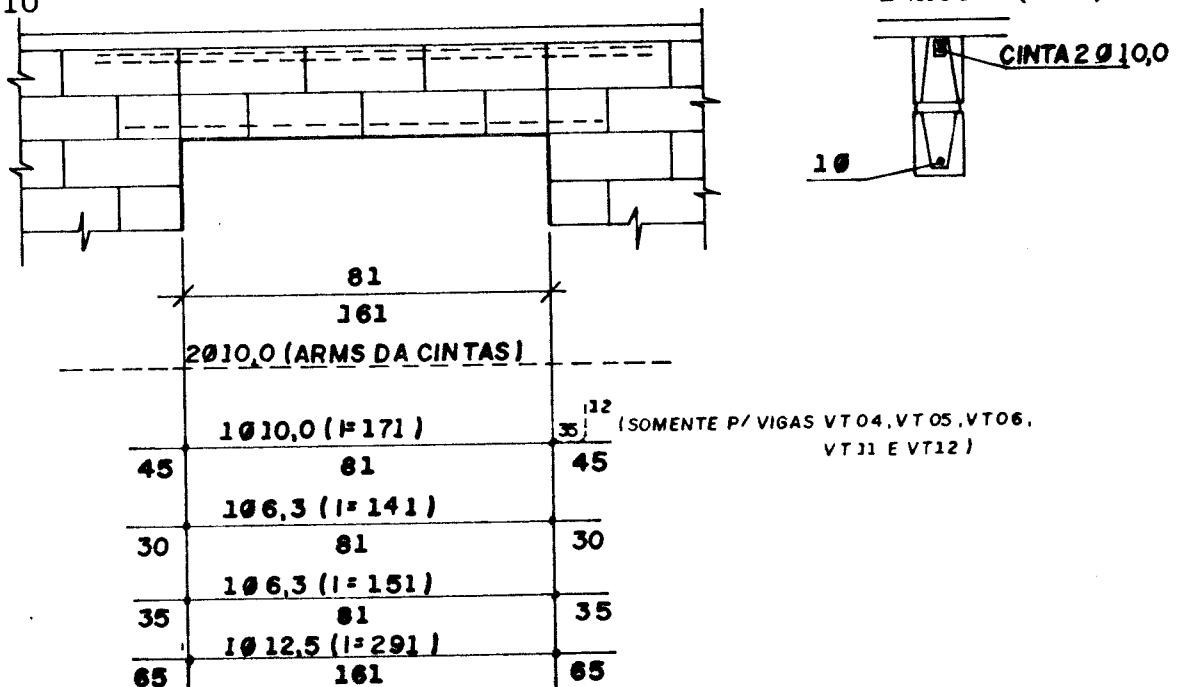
ARMAÇÃO DAS VIGAS DO TÉRREO, PRIMEIRO E SEGUNDO PAVIMENTOS.
